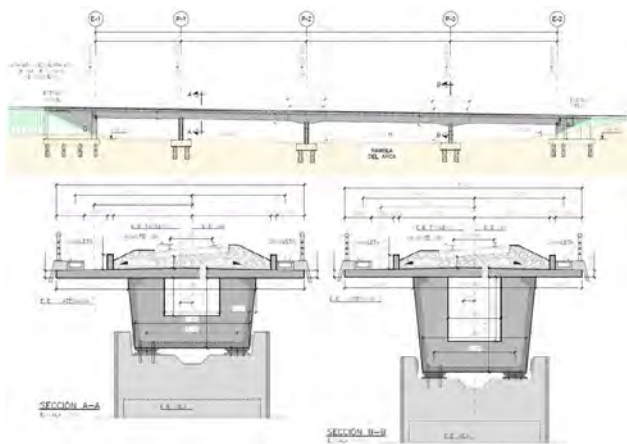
Viaducto sobre la Rambla del Arca. Alzado longitudinal y secciones sobre pila.
